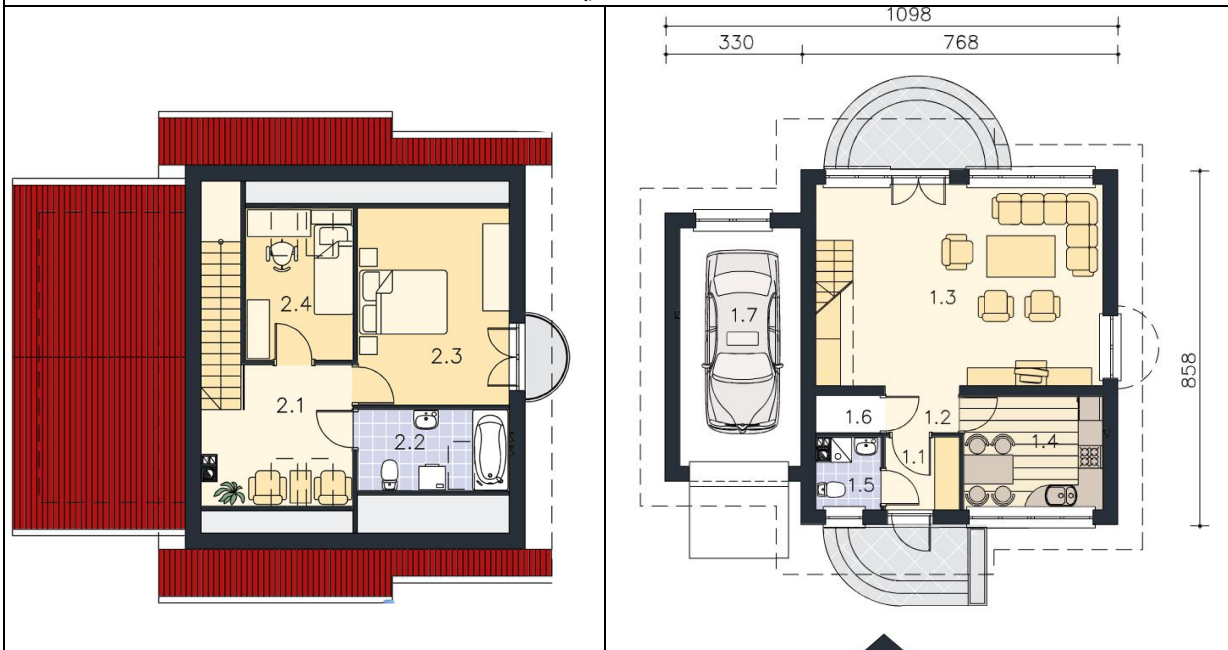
احد النماذج المتاحة وهو ذو مسطح 64 م²
